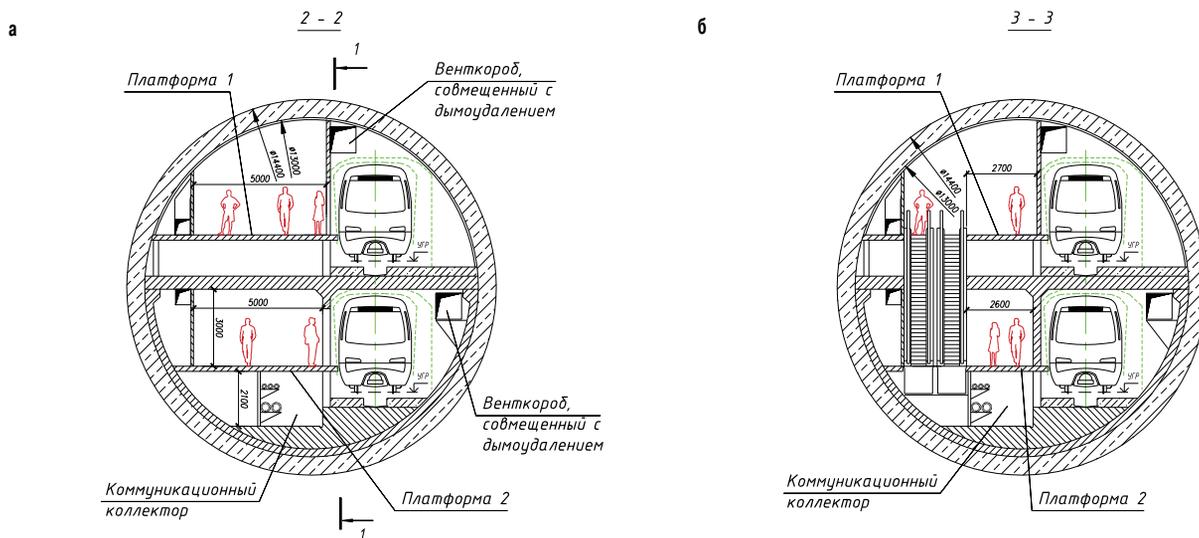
Поперечное сечение: а – зона посадки; б – зона пересадки
